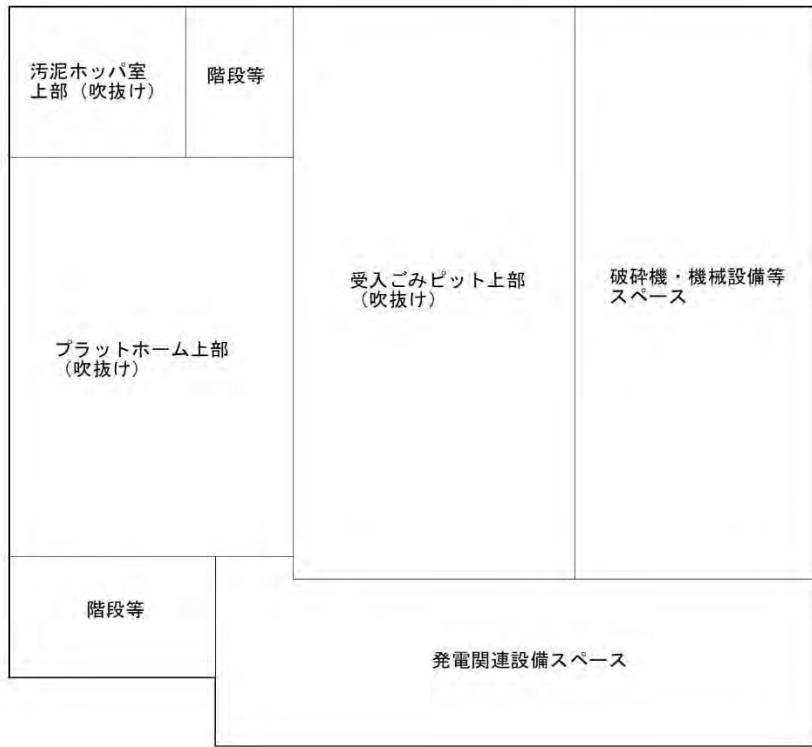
(3) 廃棄物受入棟平面図 (2 階)
